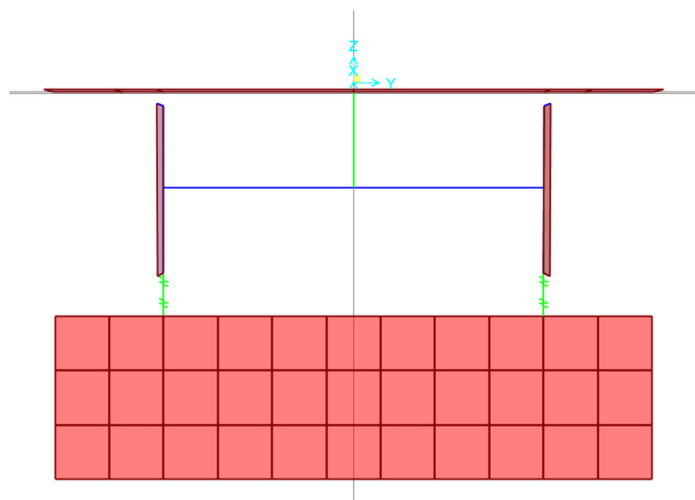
Particolare modellazione spalla con link rigidi ed isolatori
